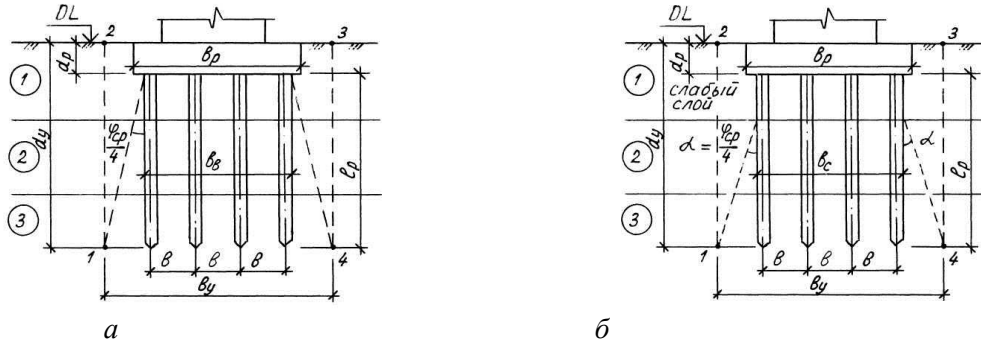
Схемы построения условного свайного фундамента при отсутствии слабых грунтов – а, при наличии слабого слоя в пределах толщи прорезываемой сваями – б: 1 – слои грунтов, b_y – ширина условного фундамента
